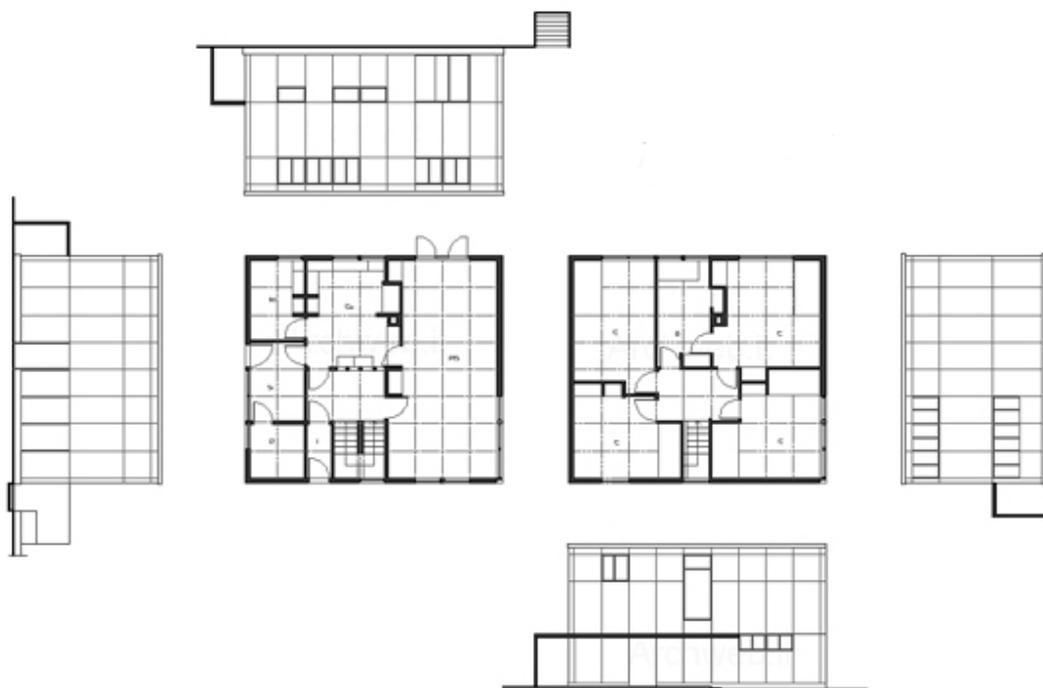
Casa Unifamiliar de Walter Gropius, Weissenhof (Alemanha, 1927). Em planta observa-se a malha da modulação, rebatida nas fachadas indicando que a malha reflete nas três dimensões. Observa-se também as linhas simples que conformam as fachadas, indicando a simplificação das soluções (característica do Estilo Internacional do Modernismo). Imagem editada a partir de [http://www.archweb.it/dwg/arch\\_arredi\\_famosi/Gropius/unifamiliare\\_Weissenhof/casa\\_unif\\_weissenhof.htm](http://www.archweb.it/dwg/arch_arredi_famosi/Gropius/unifamiliare_Weissenhof/casa_unif_weissenhof.htm). Visitado em Janeiro de 2013.
